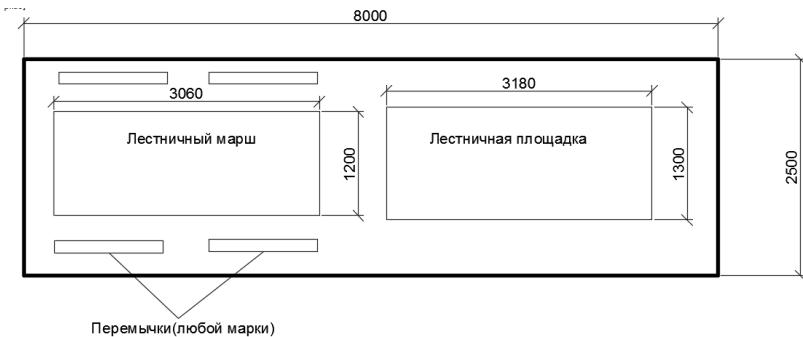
Схема раскладки лестничных маршей и лестничных площадок на транспортной платформе (выполнил студент Я.В. Офрихтер, гр. ПГС-12-16)
